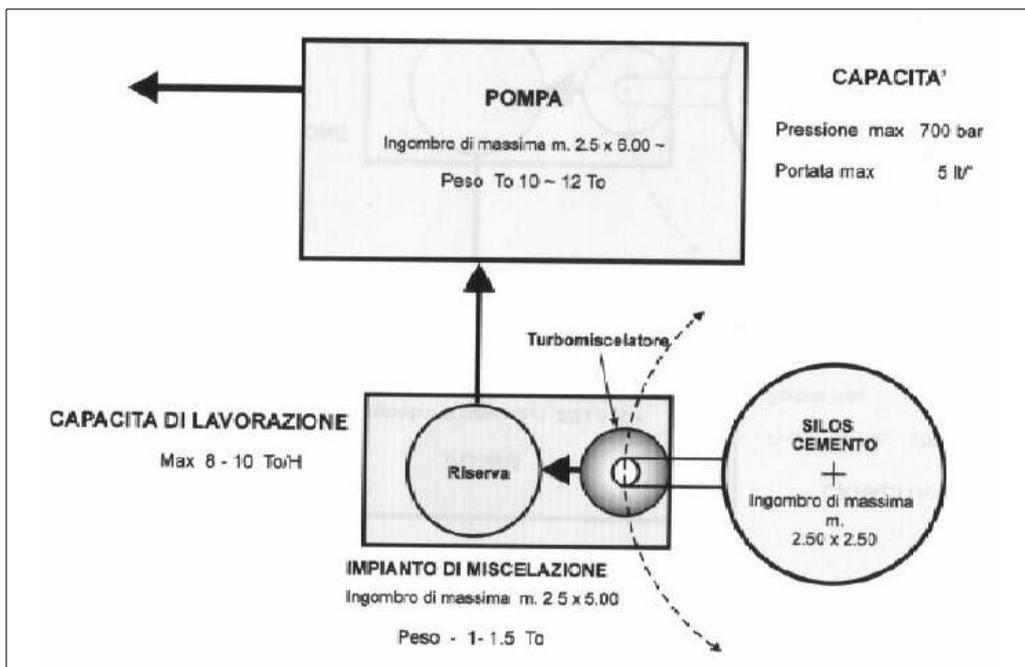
schema planimetrico- tipologico installazioni di cantiere per jet grouting con ingombri e pesi
